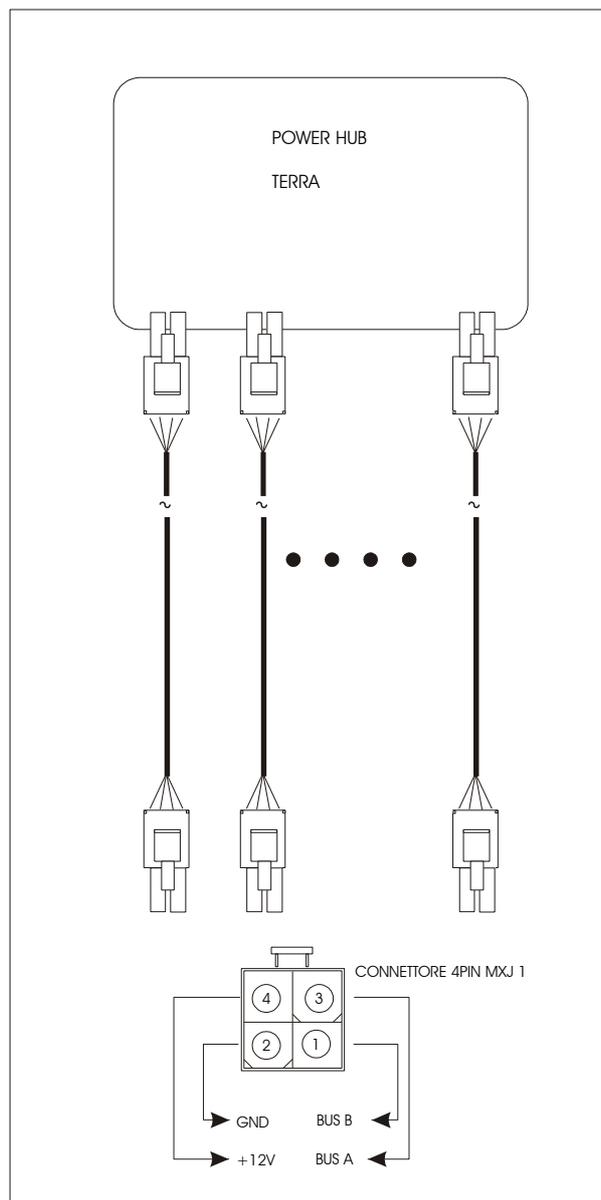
“Collegamento Power Hub Terra - Utenze pavimento”
